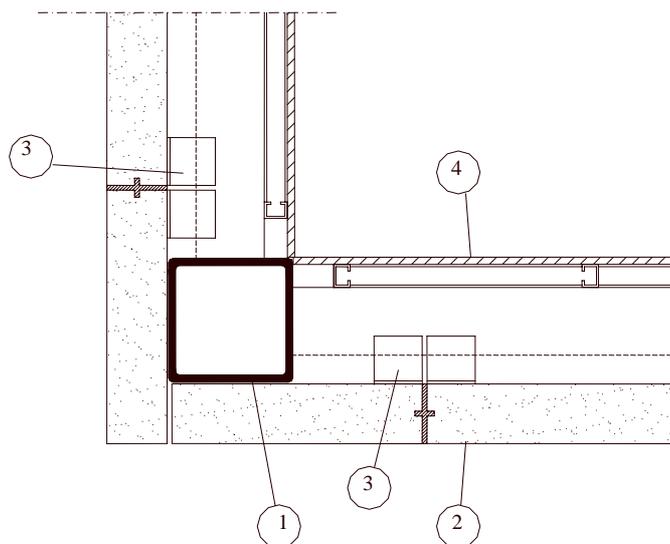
Planta: detalhe de fixação e as juntas preenchidas com *grout*.
